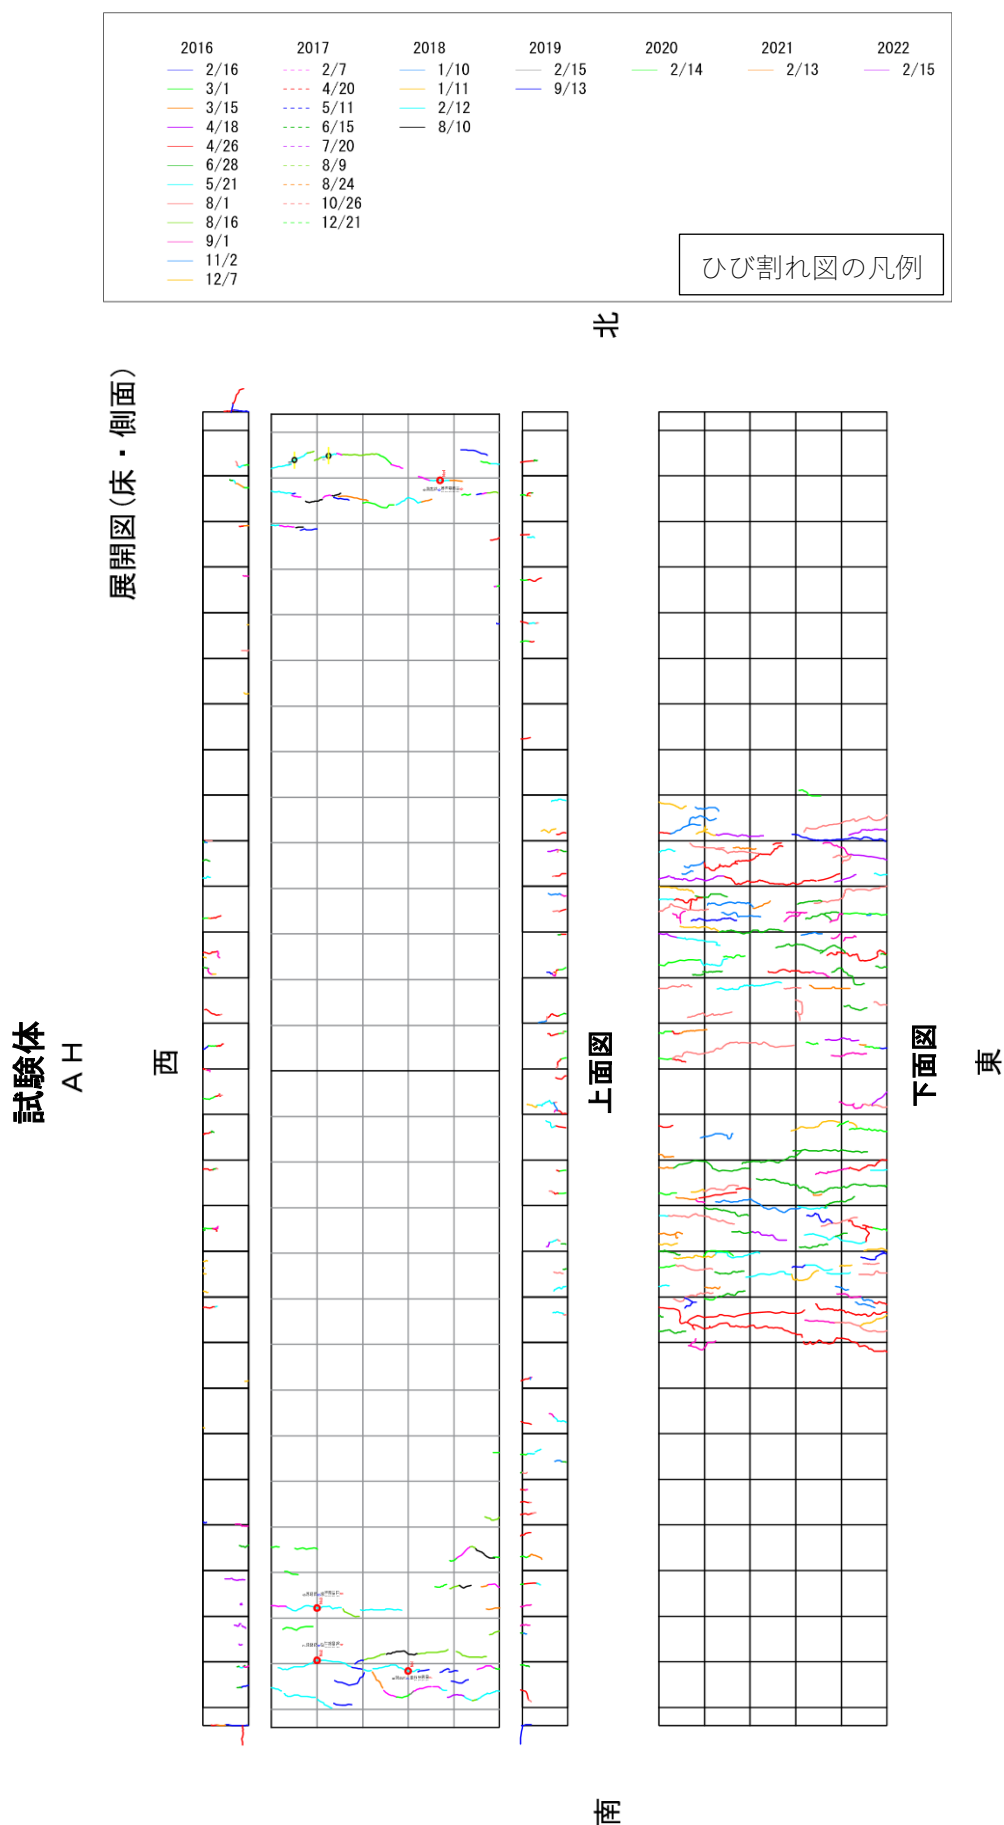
試験体 AH ひび割れ図
